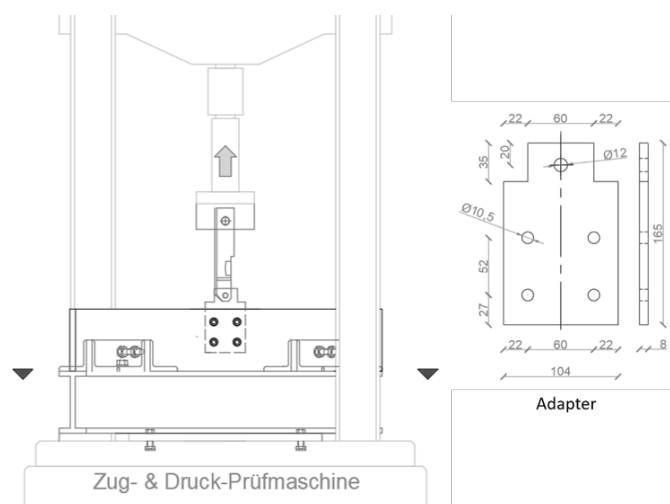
Versuchsaufbau - Geschossdeckenschluss mit Schlossschrauben
